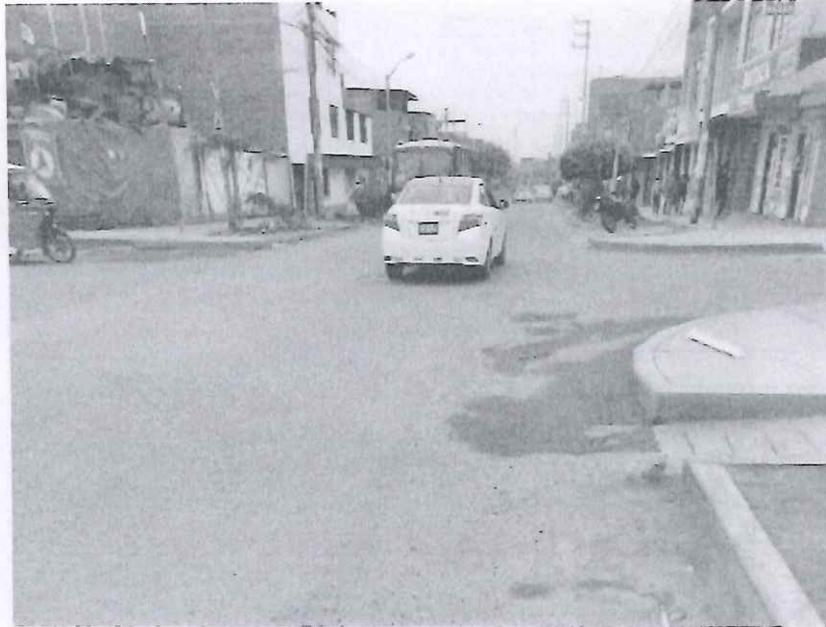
SE APRECIA GRIETAS Y FISURAS EN LA CALLE NRO 13 ENTRE LA CALLE 15 - CALLE C-8
